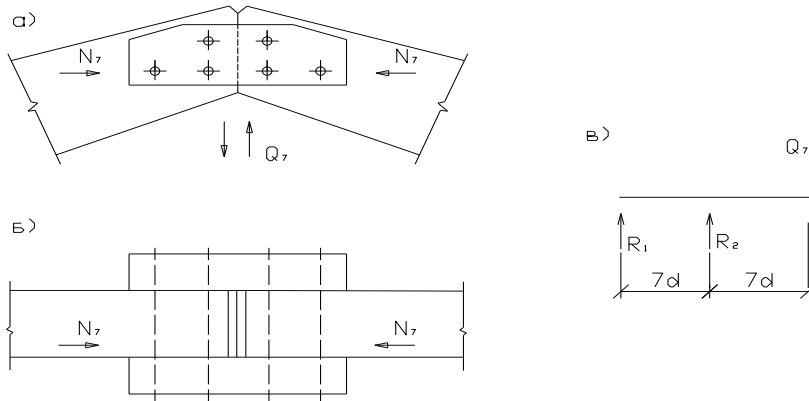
Схема крепления конькового узла: а) вид сбоку, б) вид сверху, в) схема левой стороны накладки для расчета болтов
